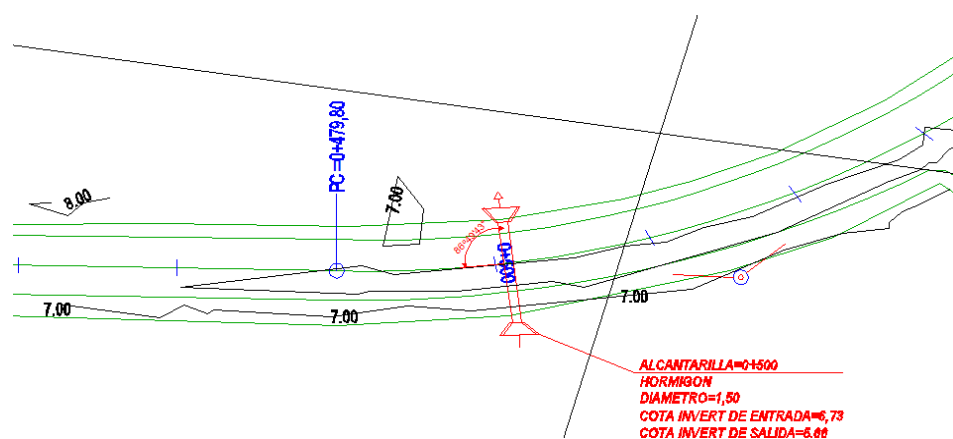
Diseño horizontal (ubicación de una alcantarilla)
